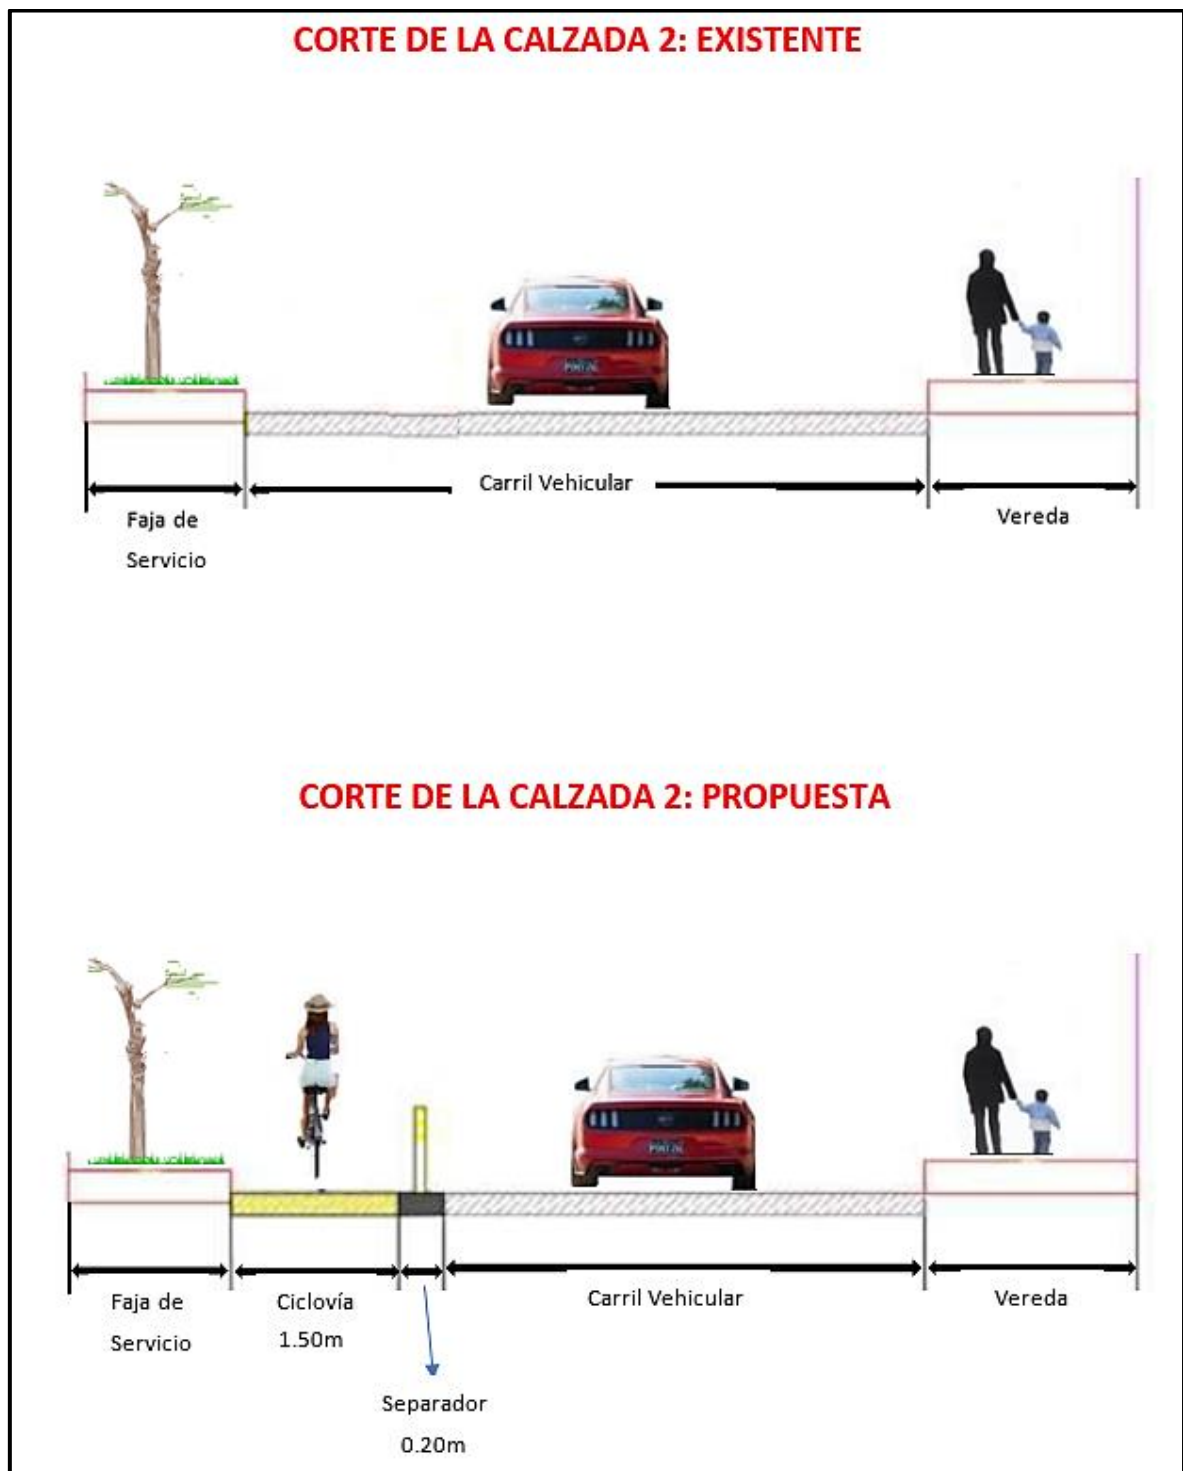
Se muestra la sección transversal existente de la calzada 2 y la sección transversal propuesta para la implementación de una ciclovía y un separador de tránsito.
